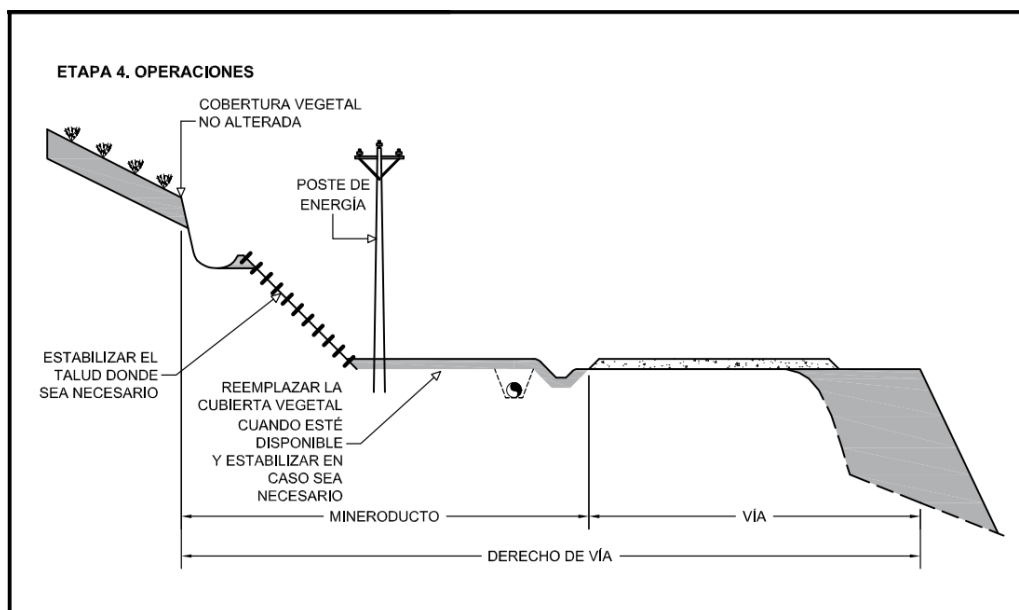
Vista en sección de un tramo en operación del mineraducto. (Fuente: Mineroducto del proyecto minero las bambas)
